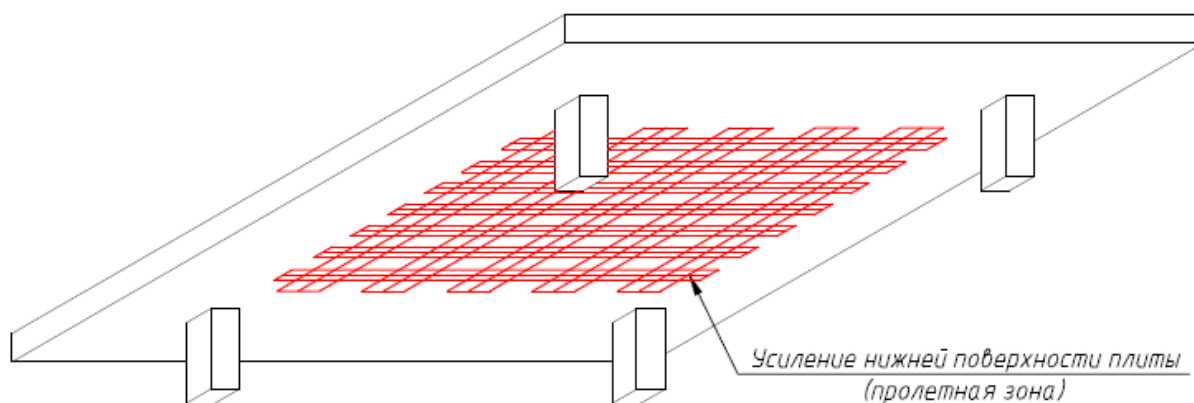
Усиление нижней растянутой (пролетной) зоны безригельного перекрытия системой внешнего армирования CarbonWrap®
